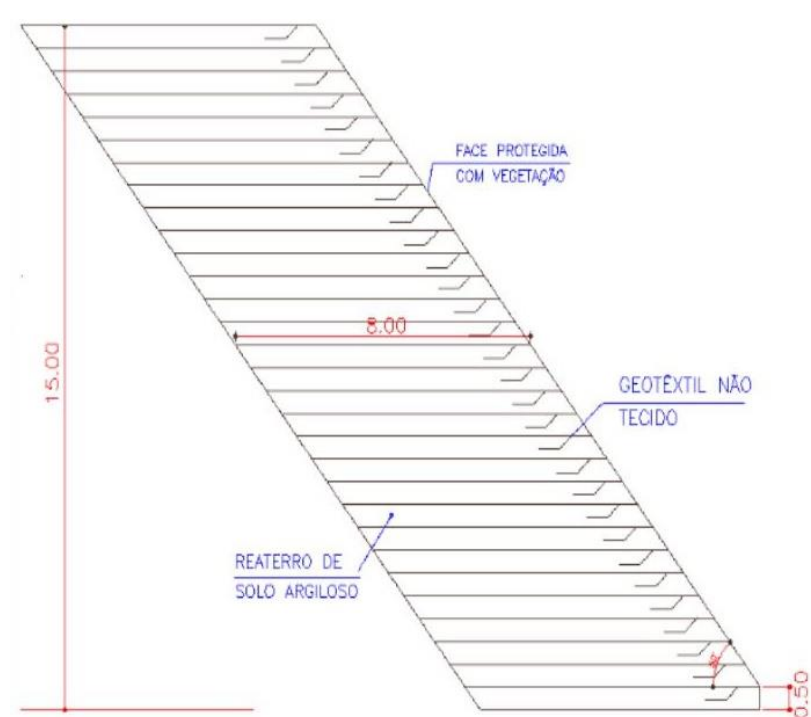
Muro em corte (medidas em metros). Fonte: Patias (2005).
